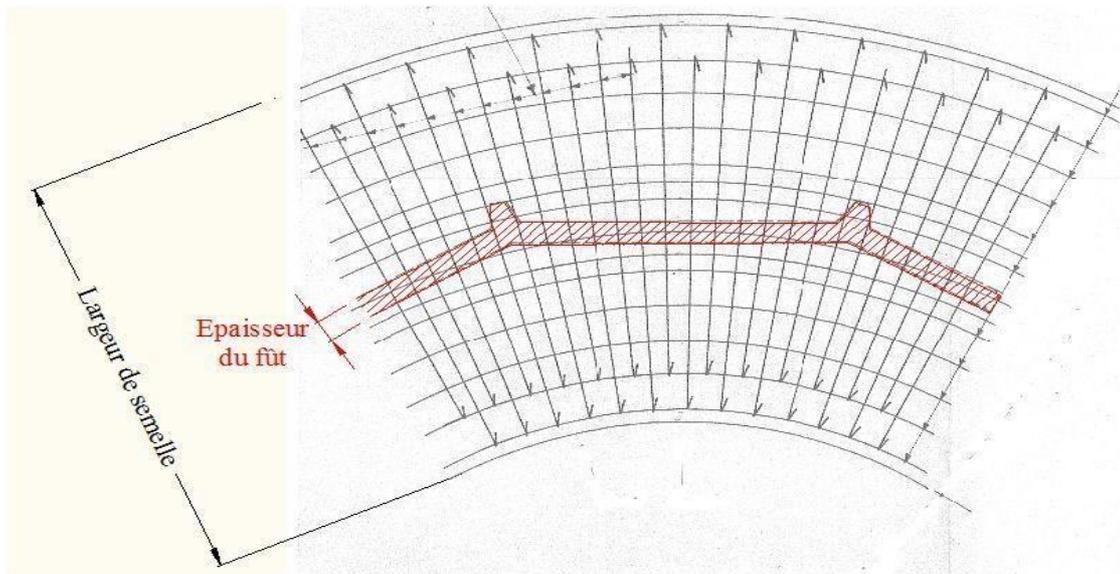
Vue en plan du ferrailage d'une semelle de fondation circulaire
